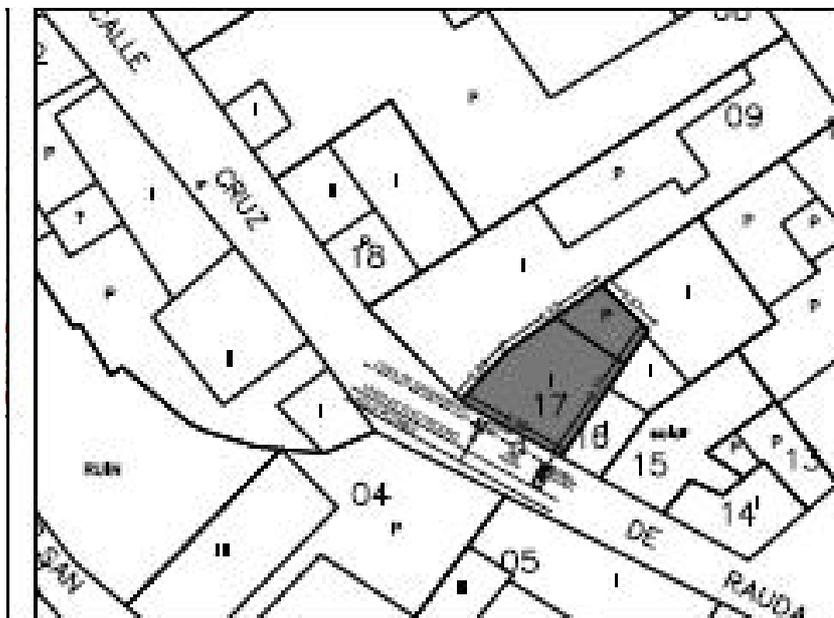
PLANO DE EMPLAZAMIENTO
